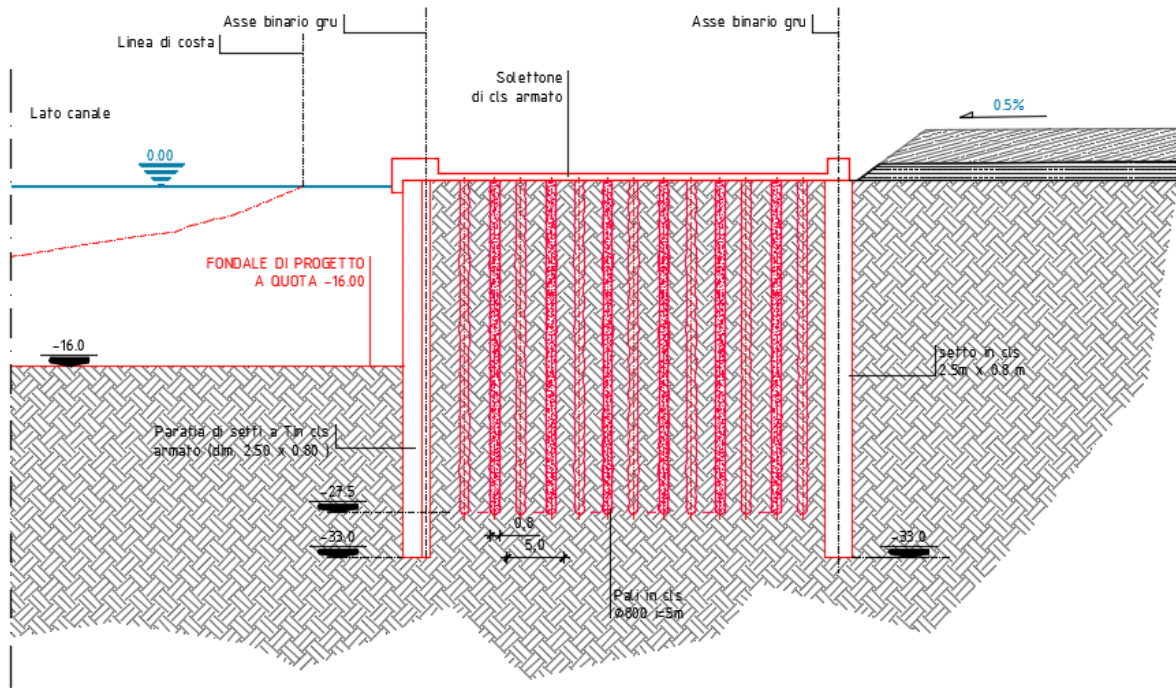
Fasi costruttive: esecuzione dell'escavo dello specchio acqueo antistante la banchina sino a quota -16.00 m s.l.m.
